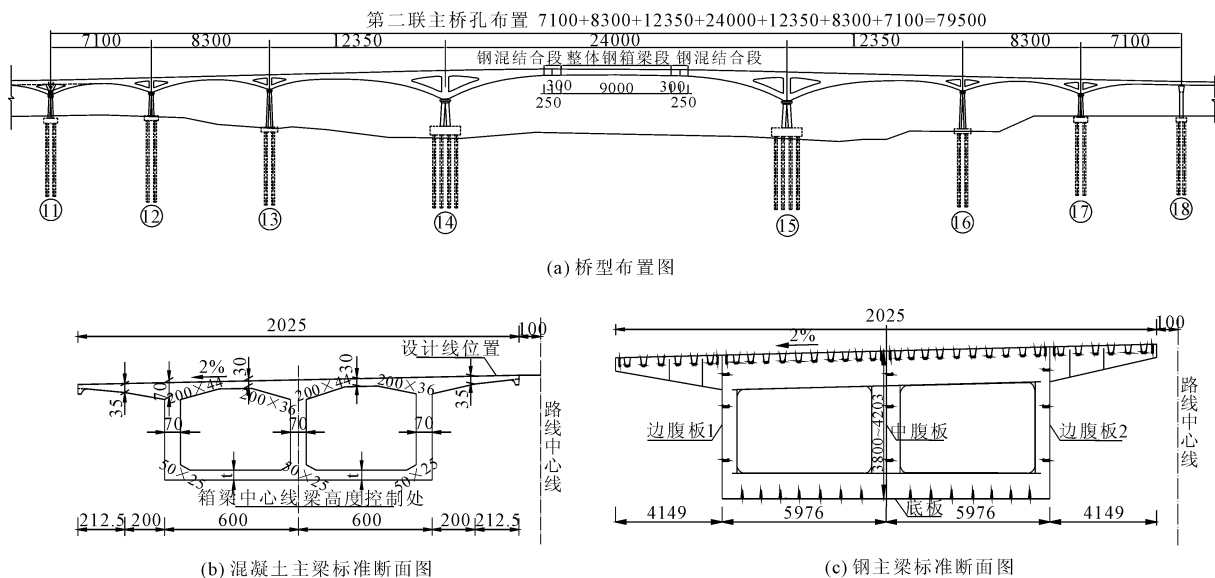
马尾大桥主桥桥型布置及标准横断面图(单位:cm)
